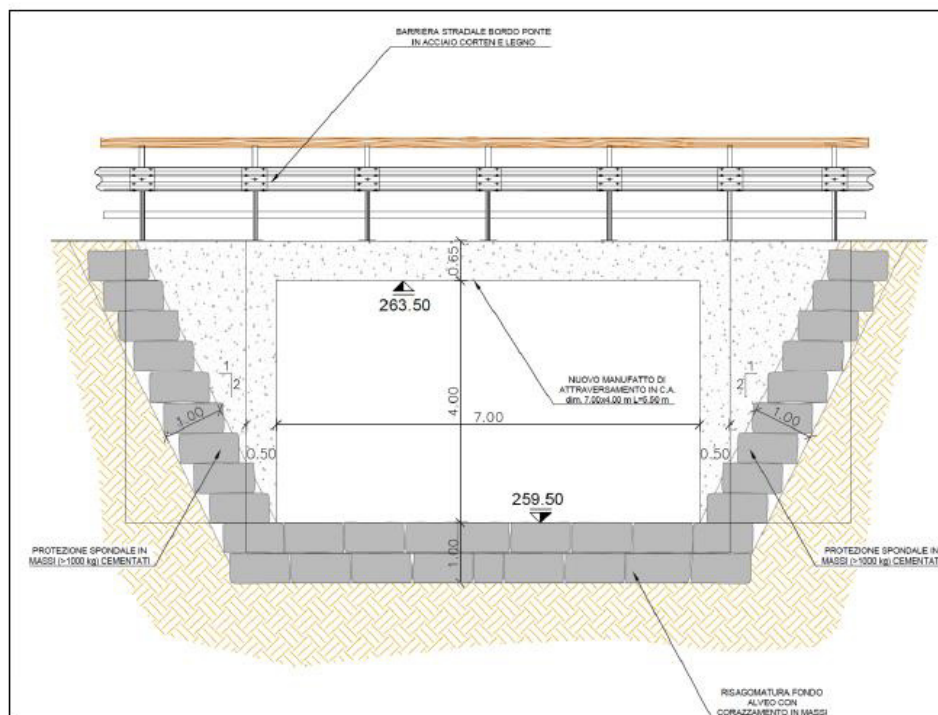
Prospetto nuovo manufatto di attraversamento in progetto
